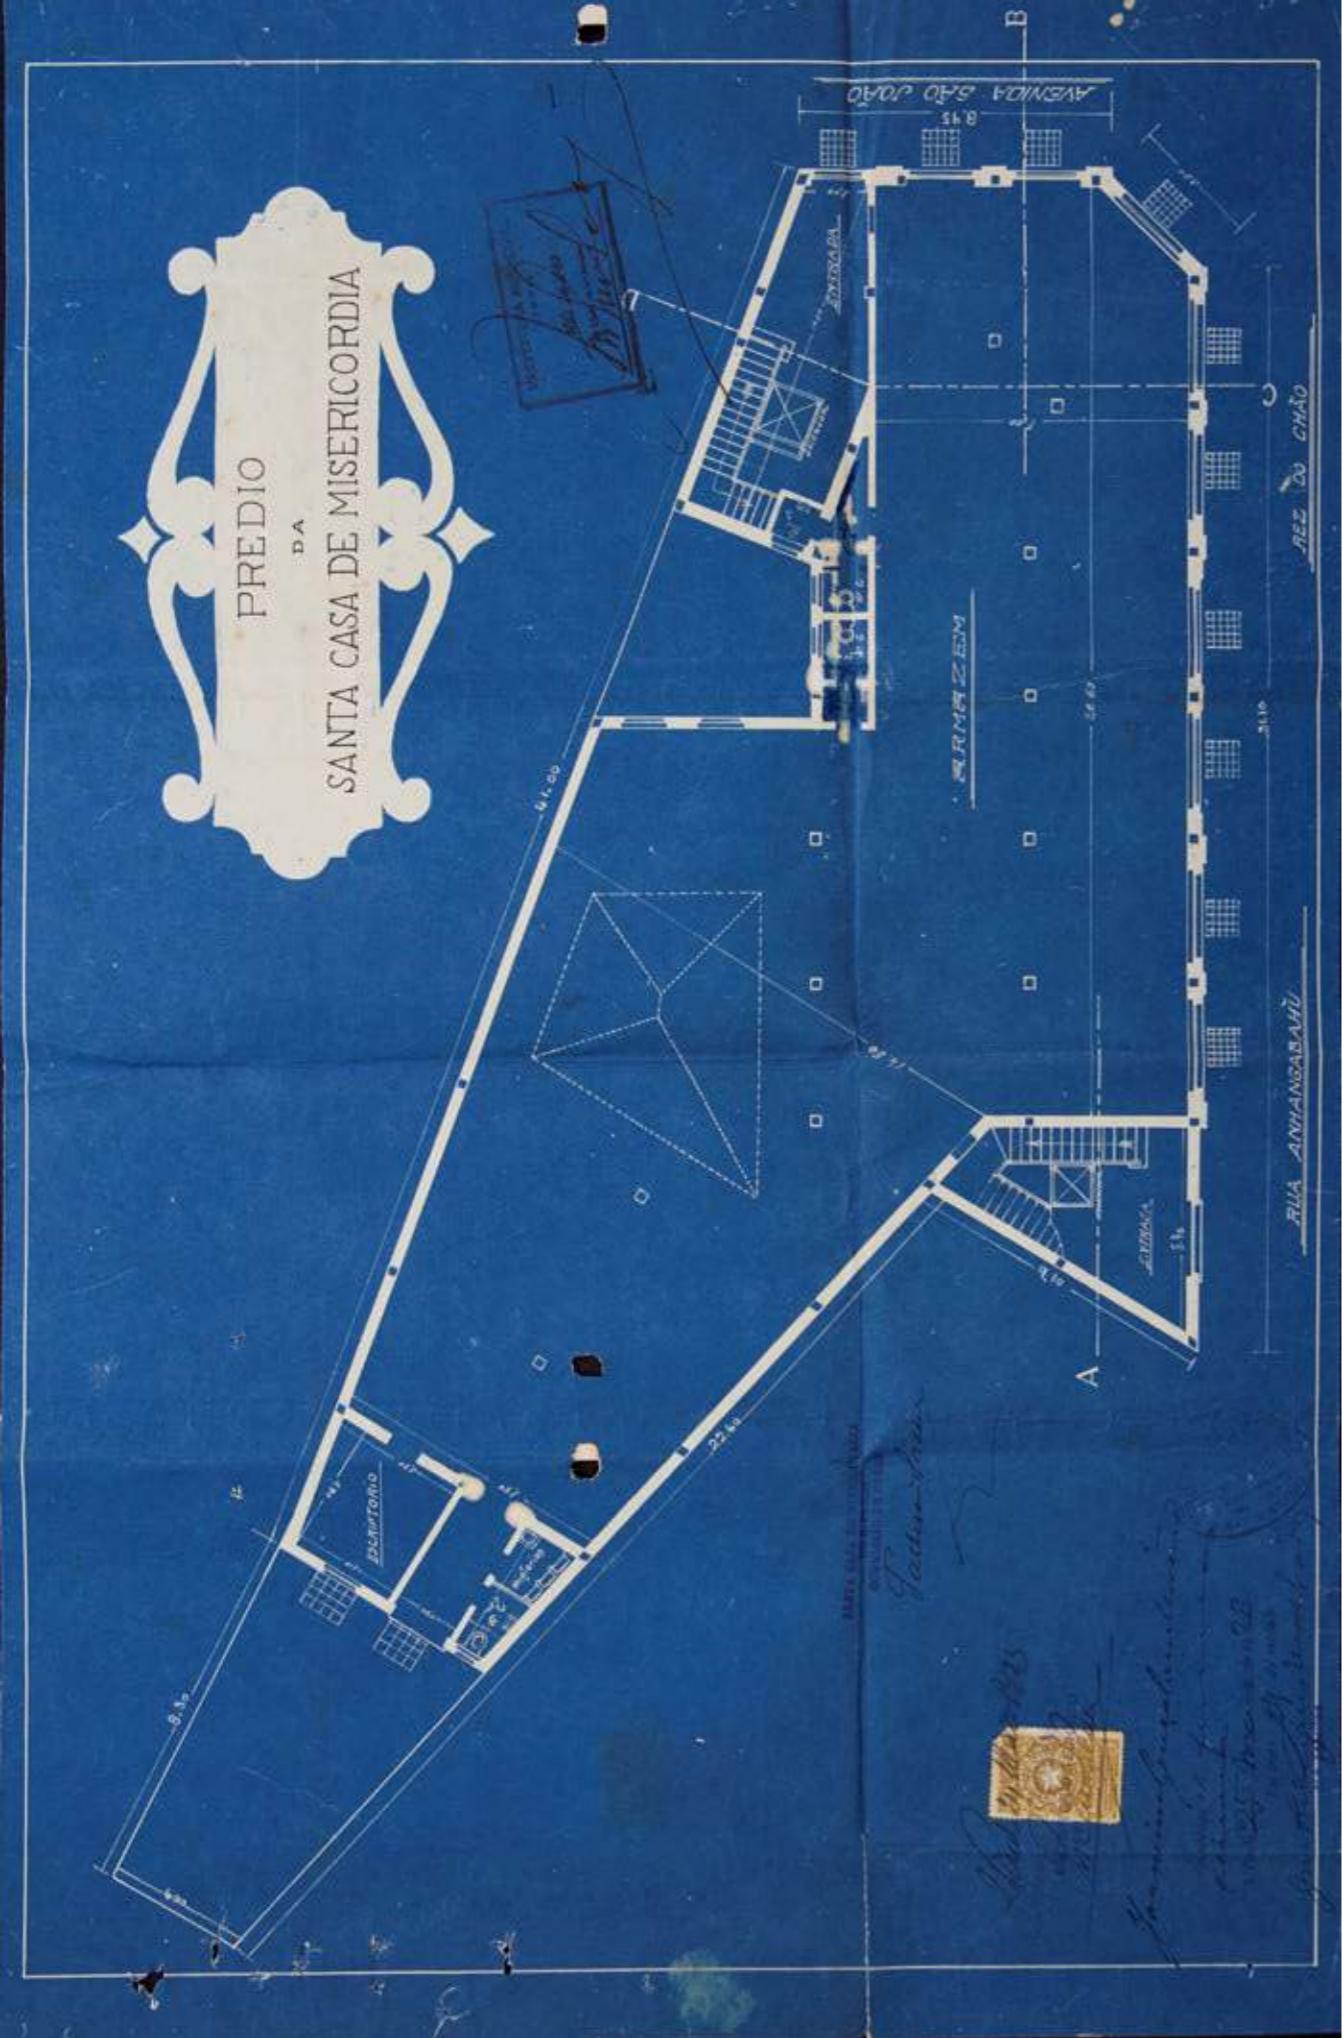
Planta do térreo, 1923. Fonte: Arquivo Histórico de São Paulo.
